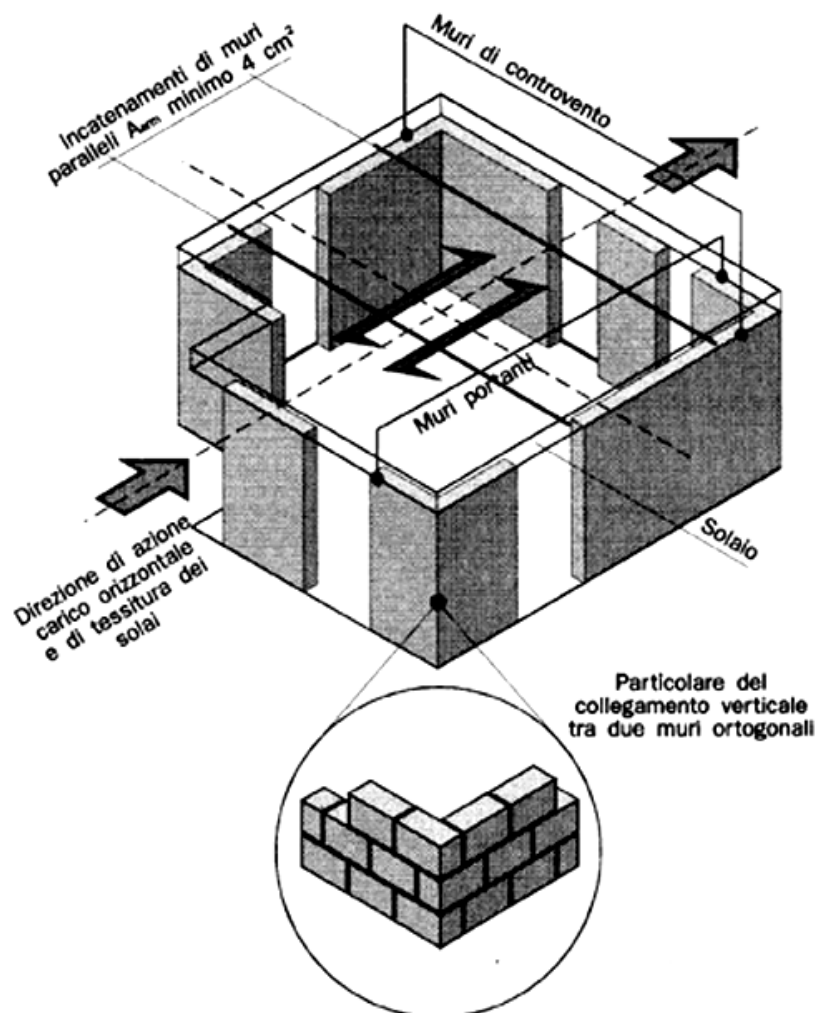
Concezione statica degli edifici a muratura portante ( 8).
